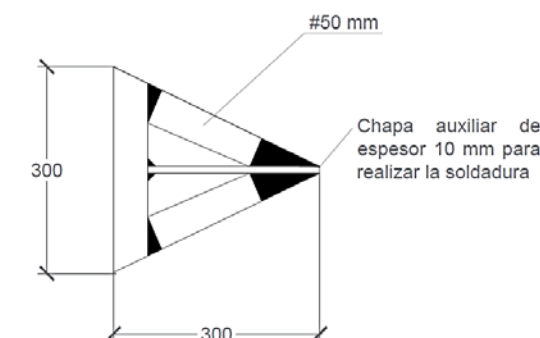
Sección transversal de las péndolas rígidas. Elaboración propia con AutoCAD.
